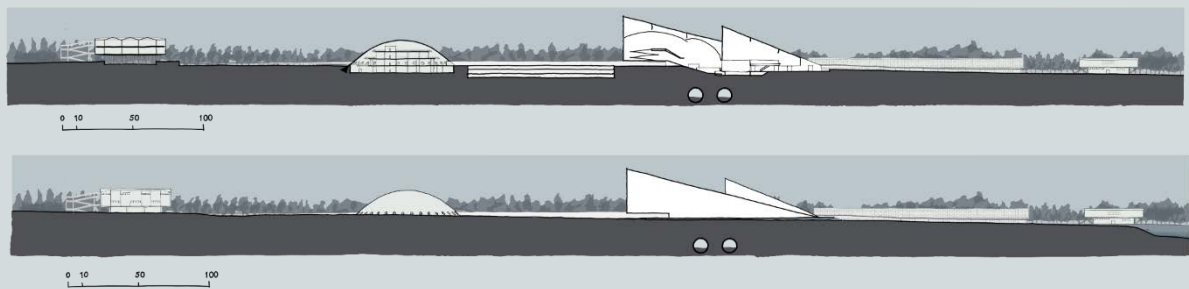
Fachada – 2000 – Versão 05 – desenho nosso.
